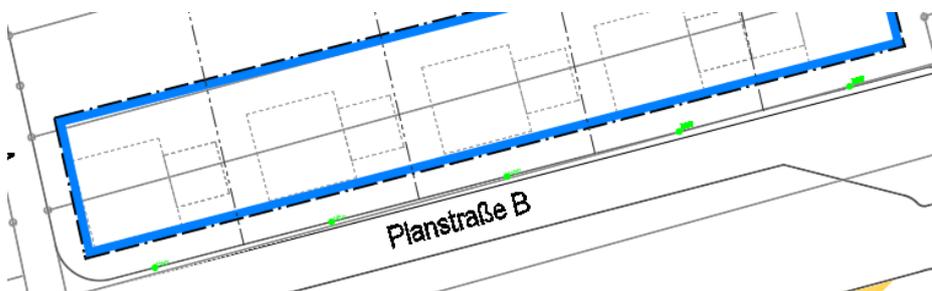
Höhenbezugspunkte (grün) entlang der Planstraße B.
